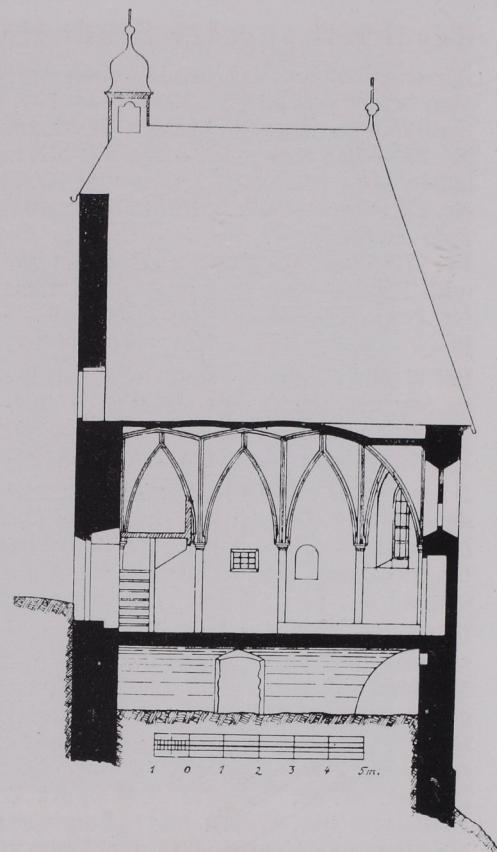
Hallein, Leprosenhauskapelle, Grundriß und Aufriß 1:200
